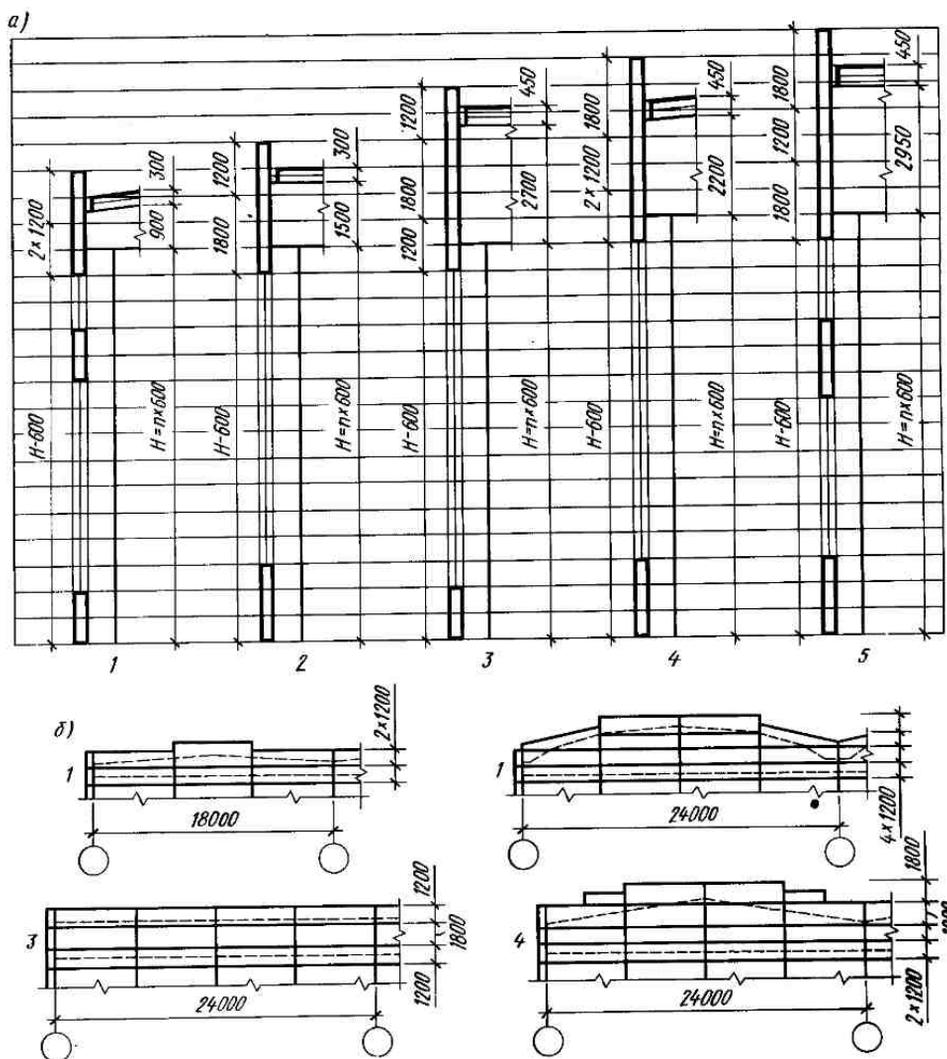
Схемы раскладки панелей в стенах одноэтажных зданий:
